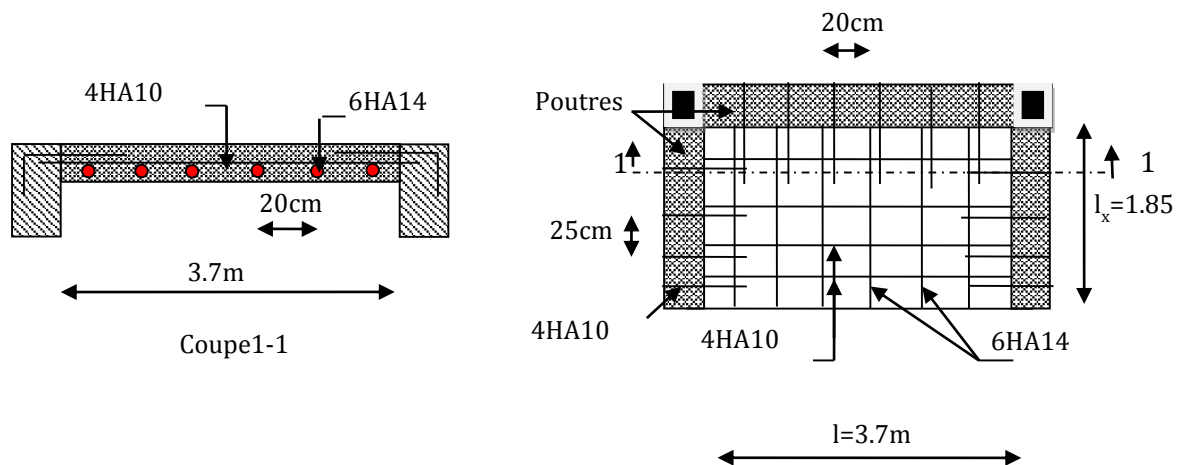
schéma de ferrailage dalle pleine trois appui (balcon)
